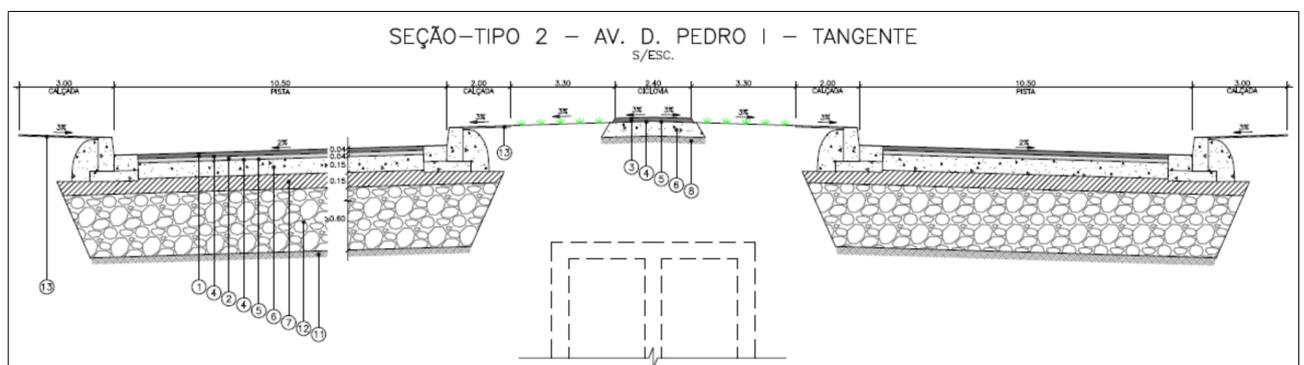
Seções-tipo 2 de pavimentos – Avenida Dom Pedro I.
